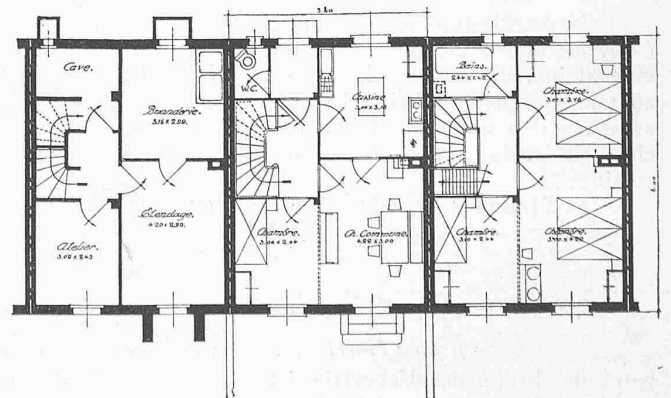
Einfamilien-Reihenhaus, Typ A. — Grundrisse 1 : 200.
